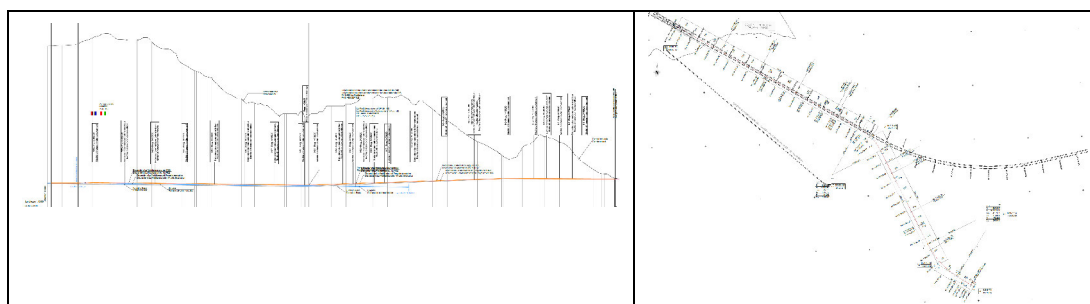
Profilo altimetrico (a) e tracciato planimetrico (b) del Cunicolo
